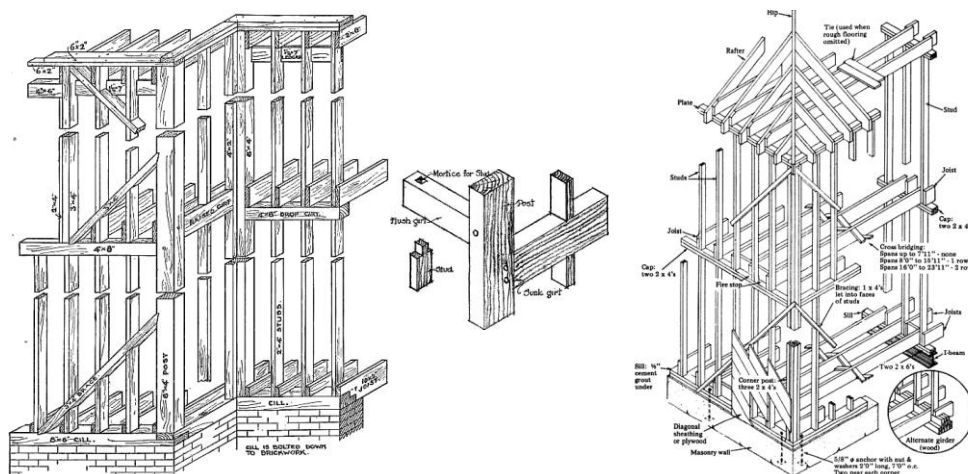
Reticulados leves “braced frame” e “modern braced frame”. Note-se as secções do pilar de canto, da travessa de pavimento e da travessa de topo no primeiro sistema e a uniformidade de secções no segundo (Jones, 1986) .
